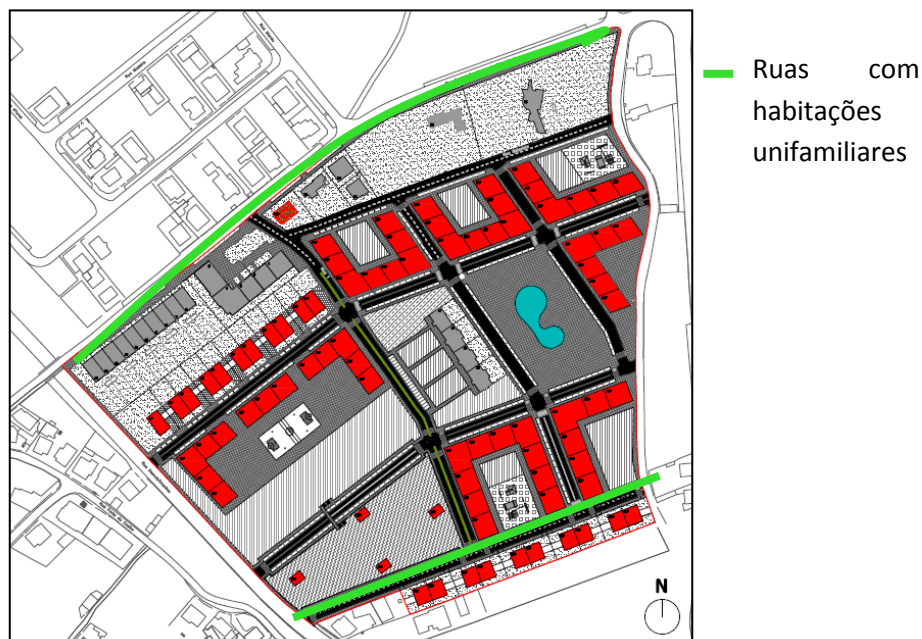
Planta síntese do edificado proposto - escala 1/5000 – Anexo 3 – peças desenhadas B22 (Fonte: 64)
